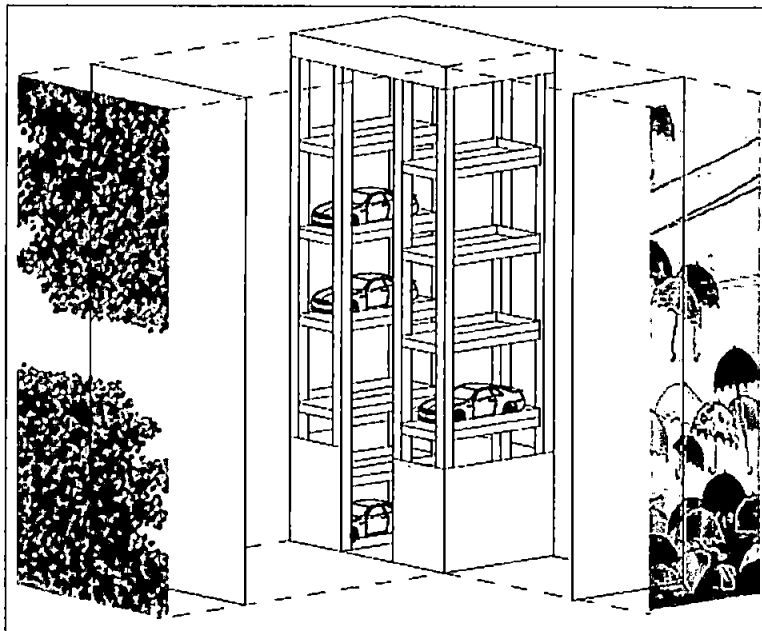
Exemplu de bună practică – propunere de animare a fațadelor structurilor de tip smart parking.
